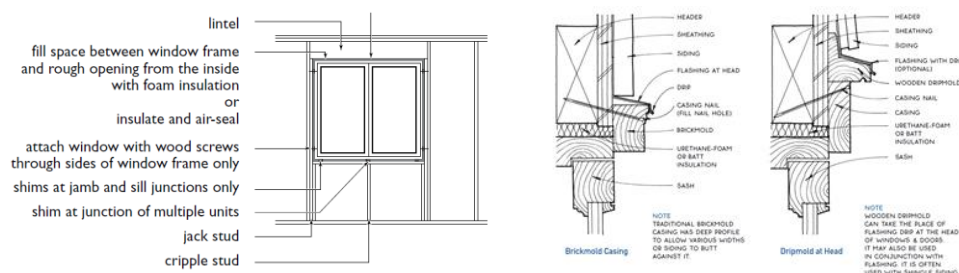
Folga de 12,5mm entre o aro da estrutura e o aro da janela (TRADA, 2008) e pormenores do lintel de um vão (Thalon, 2009).
